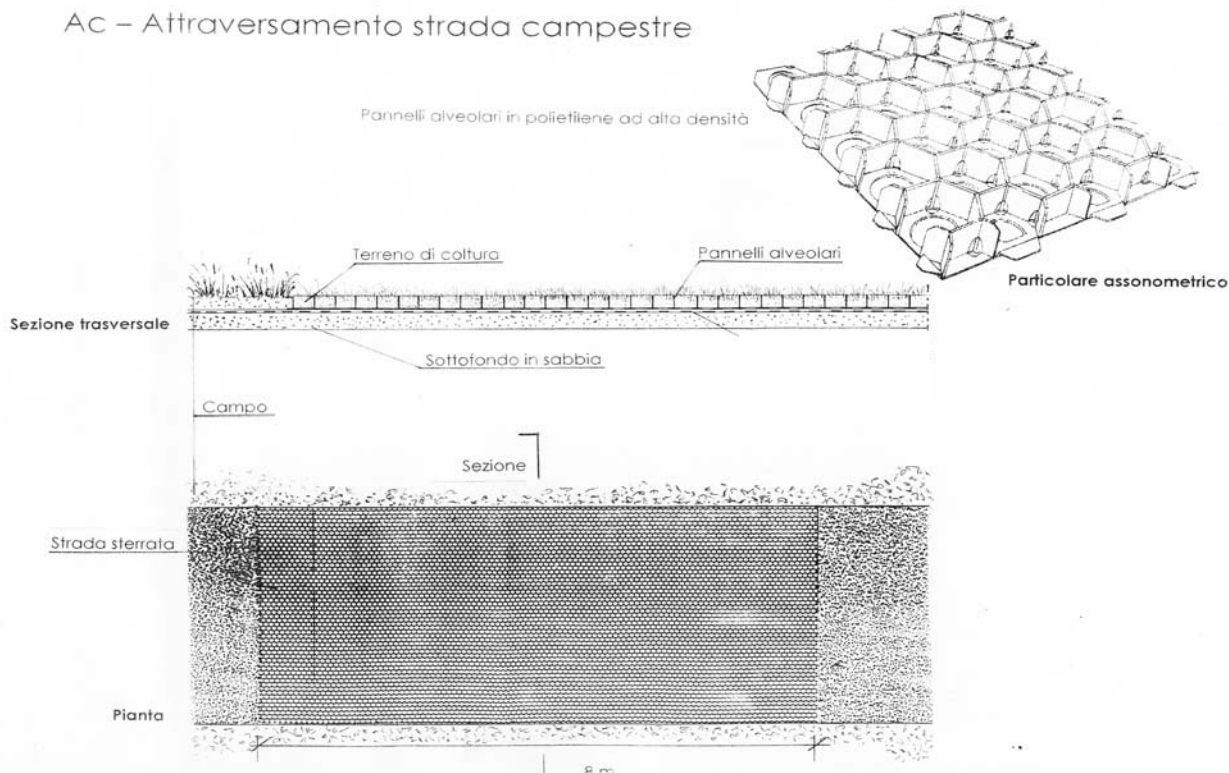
Esempio di attraversamento di una strada campestre con pavimentazione alveolare
